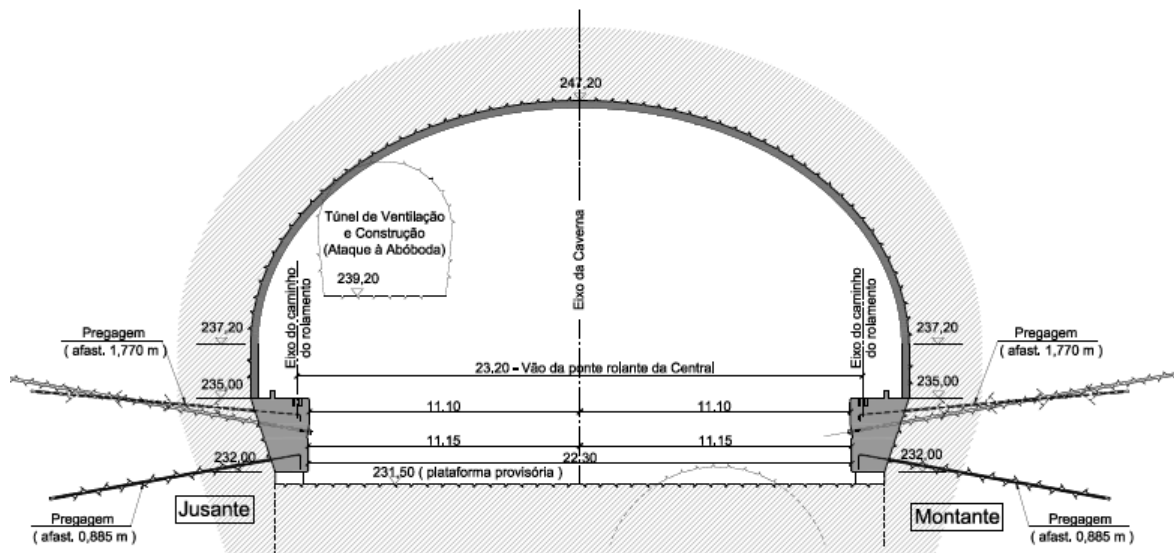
Corte das Vigas Suporte da Ponte Rolante e do Teto Falso da Central VNIII
